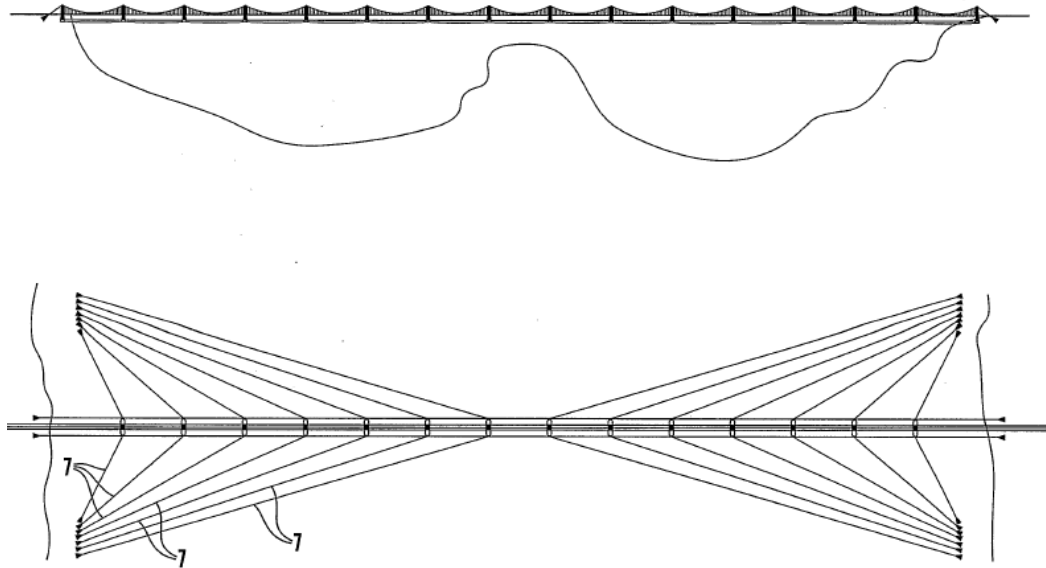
Ansicht und Grundriss ,Variante 1b (Aardal, 2005)
